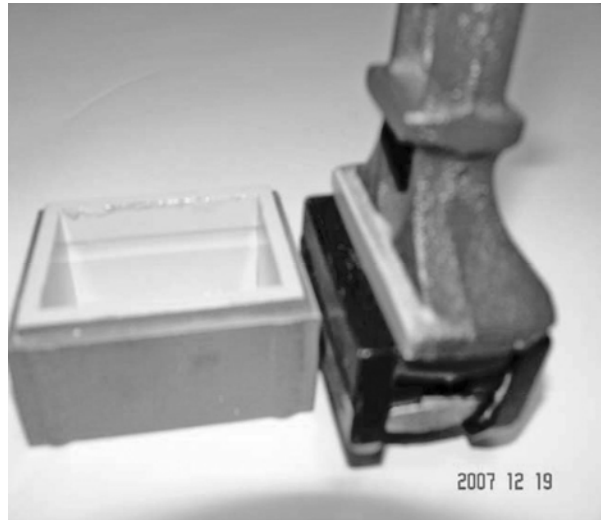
Дефекты железобетонной шпалы в зоне анкера
